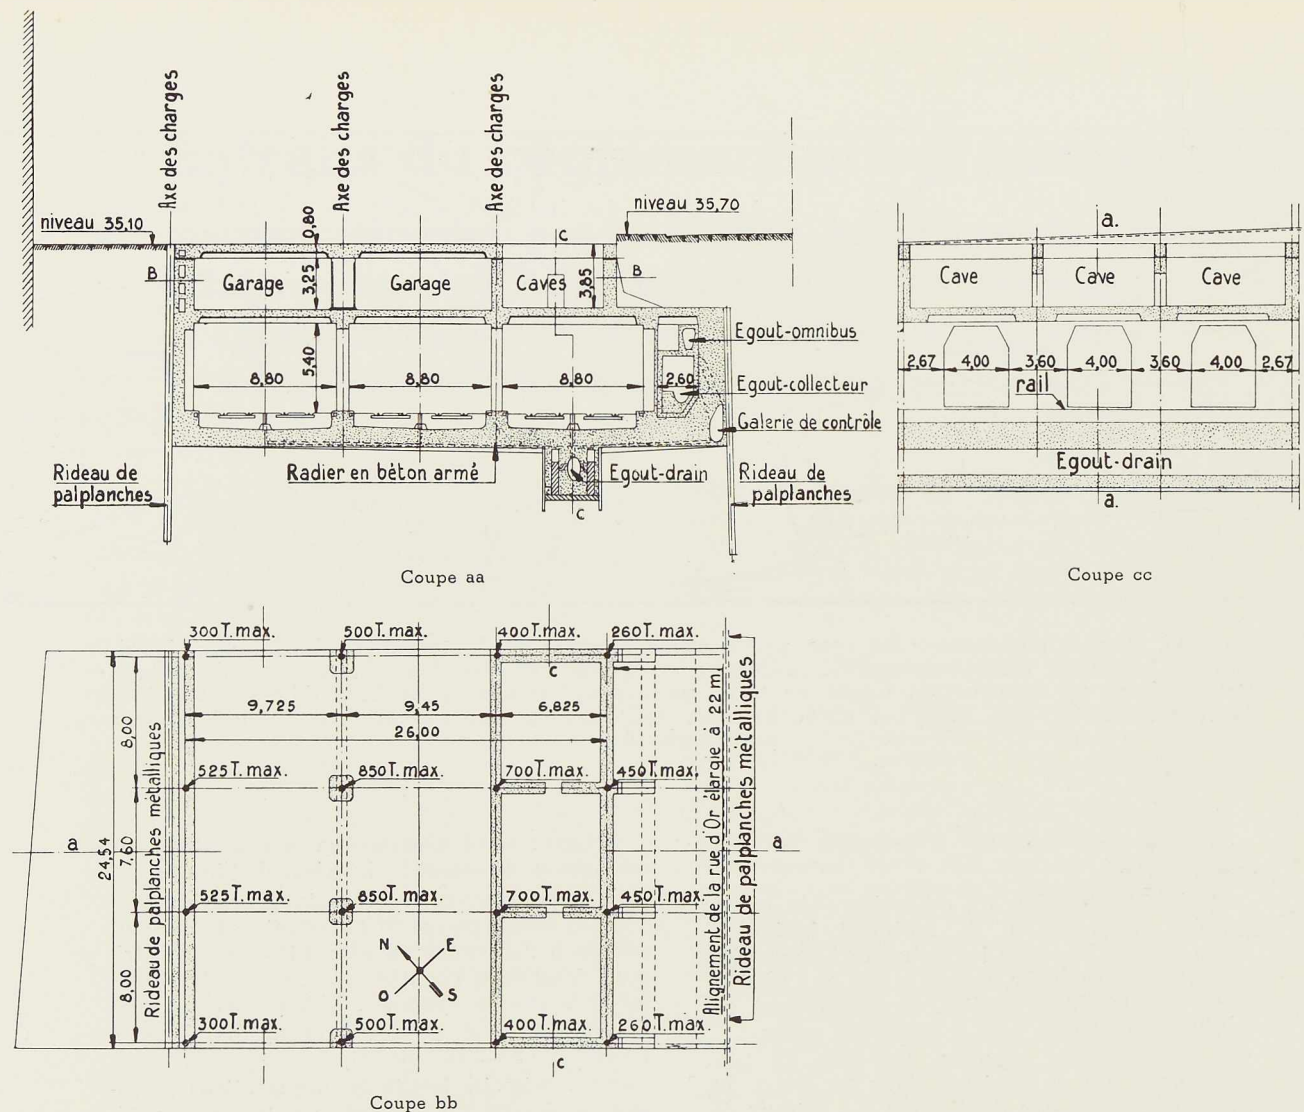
Coupes en long, en travers et en plan dans le tunnel et le garage.
